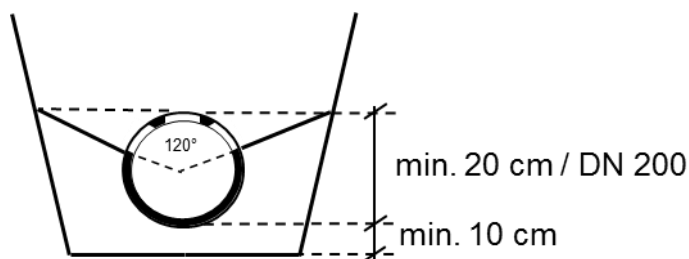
Coupe transversale du lit de pose en béton pour le type 4
